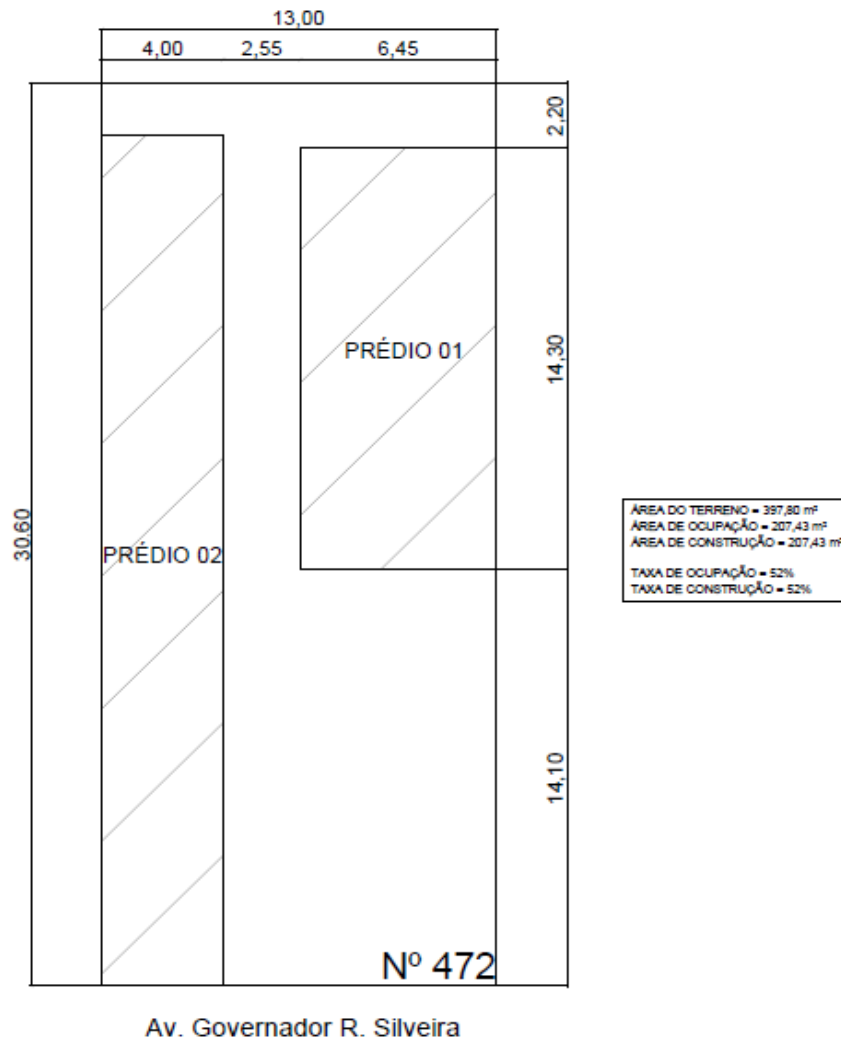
Planta de Situação do CESPP (Próprio autor)
